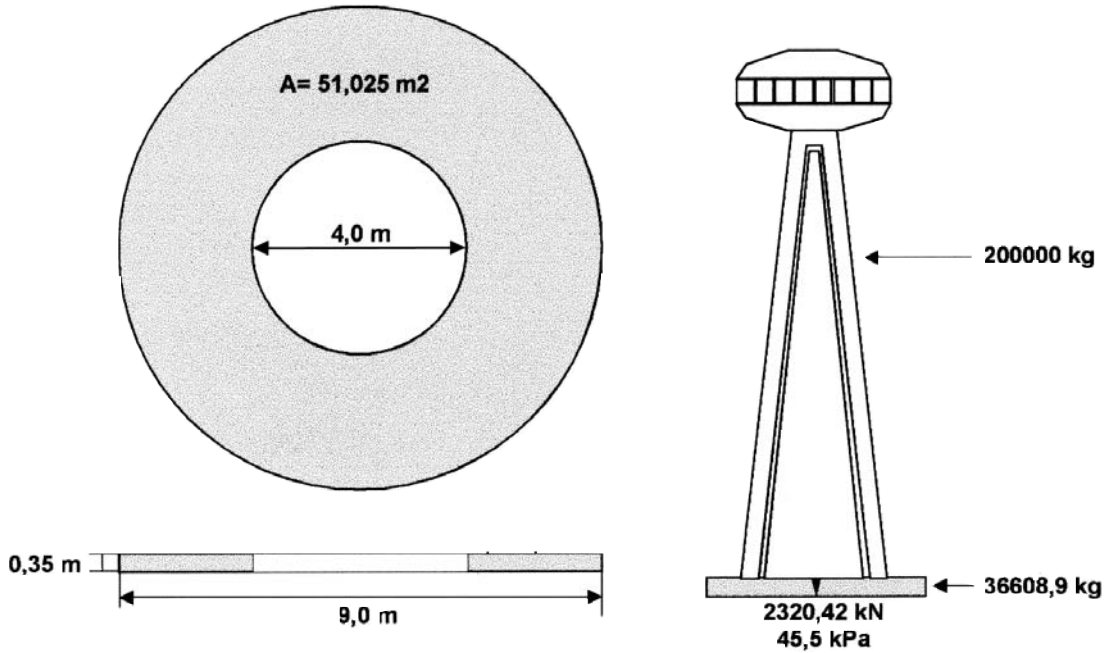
Estructura de cimentación y cargas aplicadas al terreno.
